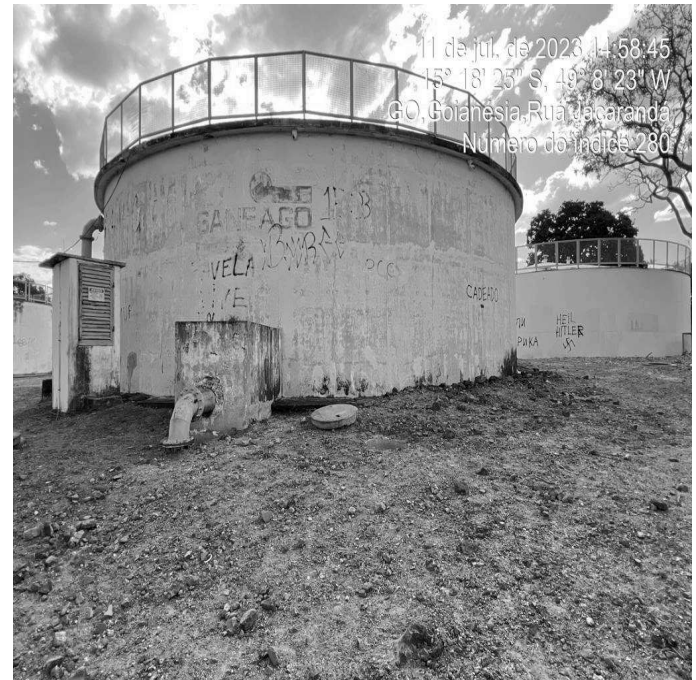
RAP 300 m<sup>3</sup> metálico - C.R. Morro da Ema com pintura desgastada.
